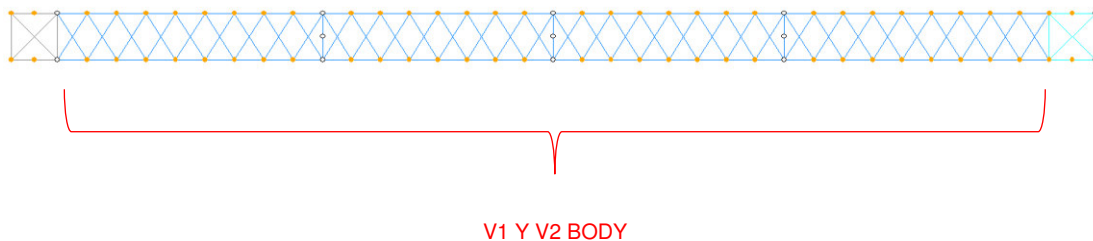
Seccionamiento en vigas tipo 1 y 2
